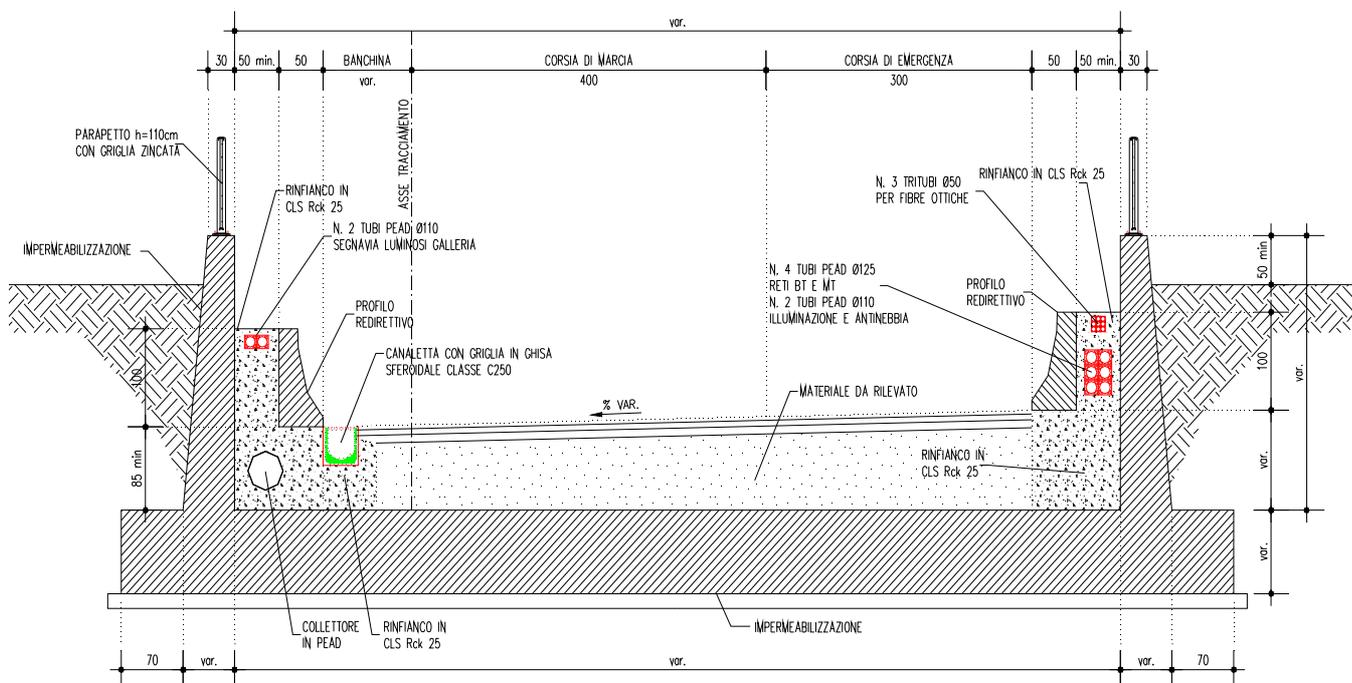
SEZIONE TRASVERSALE TRINCEA DI MURI AD U
